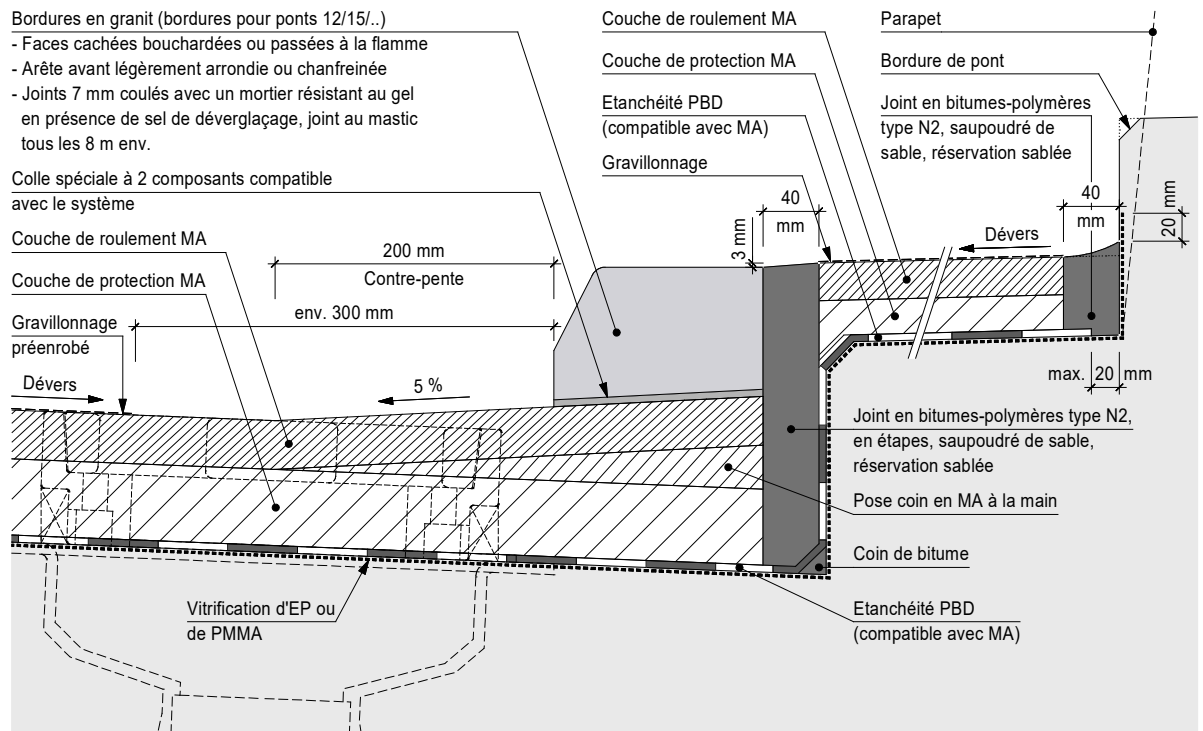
Système d'étanchéité PBD - Raccord aux trottoirs - Bordure de trottoir collée - Point bas
